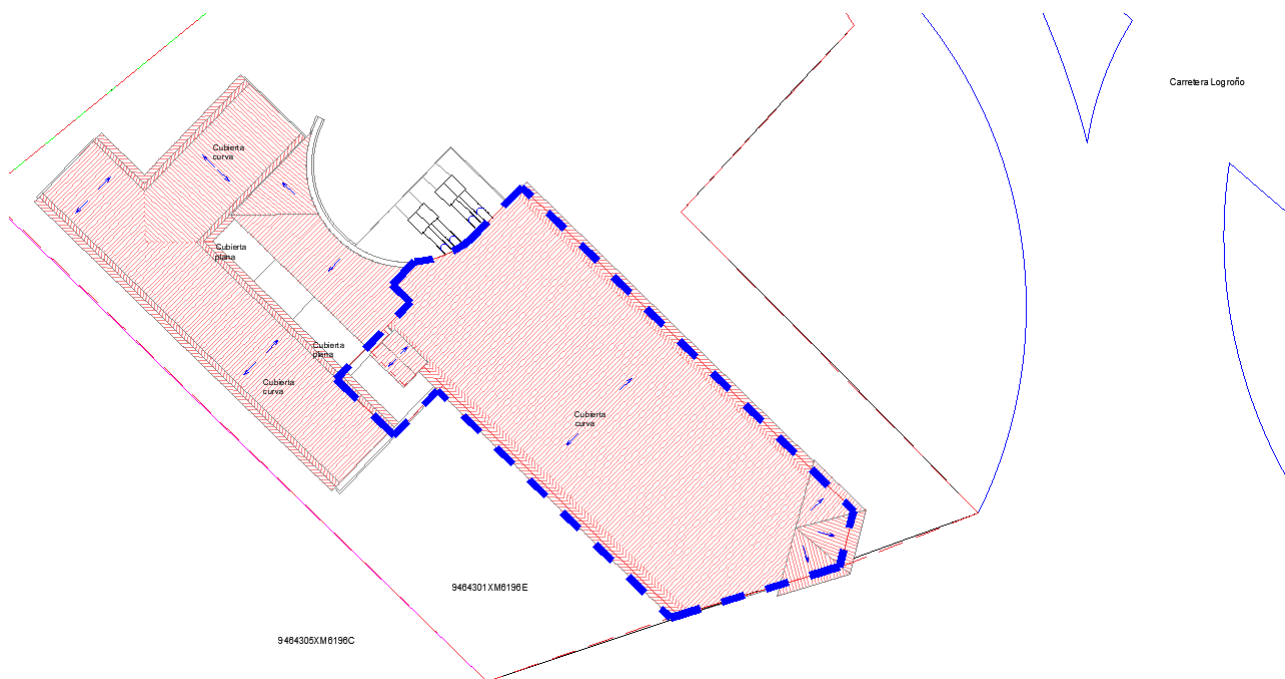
Planta de conjunto edificado. Se marca con línea perimetral a trazos el Centro Cívico. La zona rayada y no perimetrada corresponde a parroquia.
